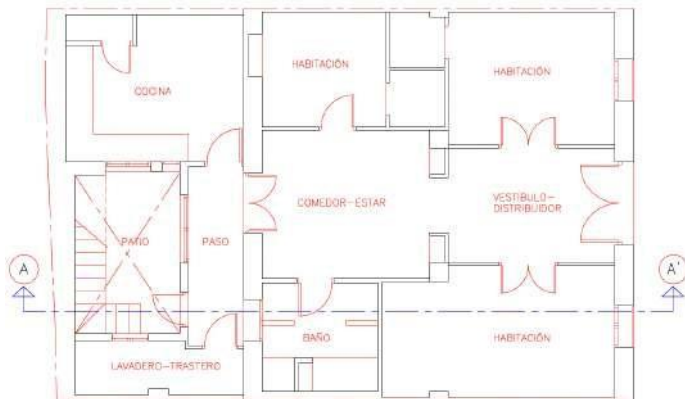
Planta distribución carpinterías de vivienda existente. Fuente propia
